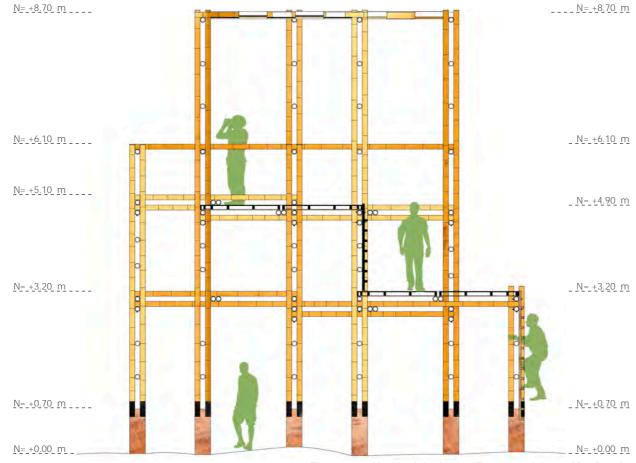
Alzado del mirador. Fuente y elaboración: Propia
